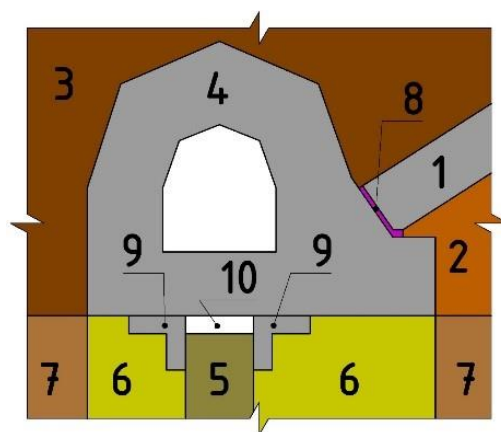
Схема узла сопряжения экрана и стены посредством бетонной галереи
